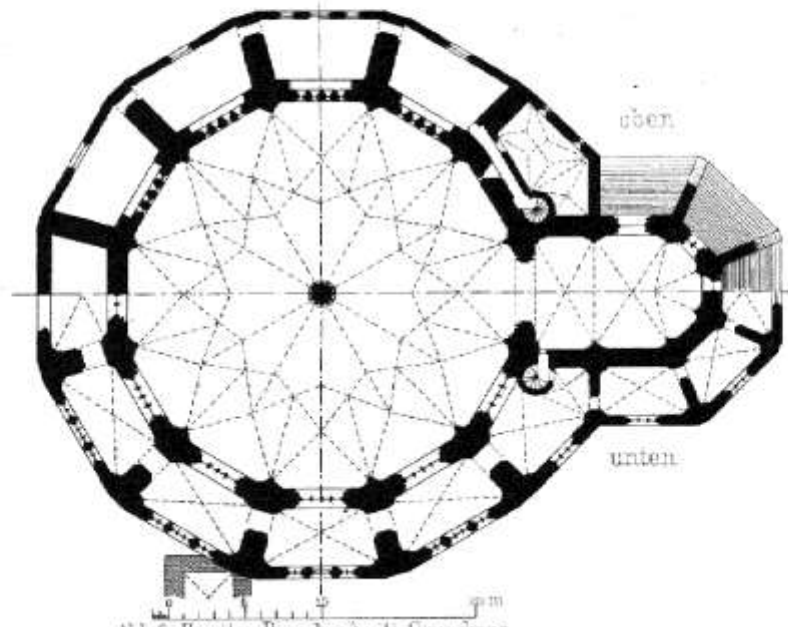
Zweiter Bauabschnitt. Grundriss
